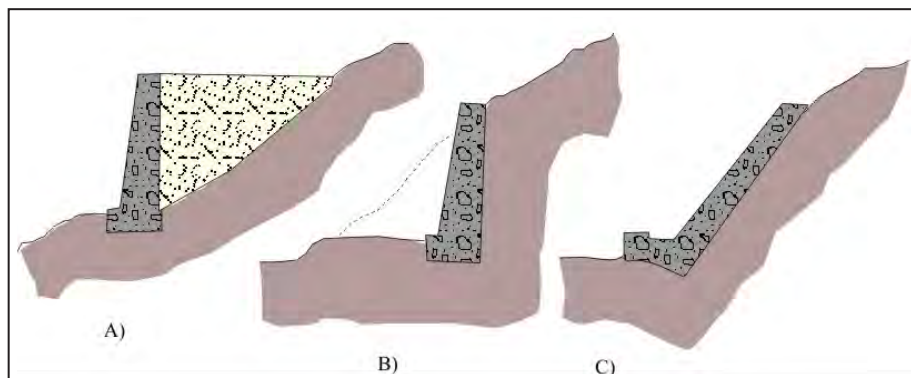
a) muro de sostenimiento; b) muro de contención; c) muro de revestimiento.
